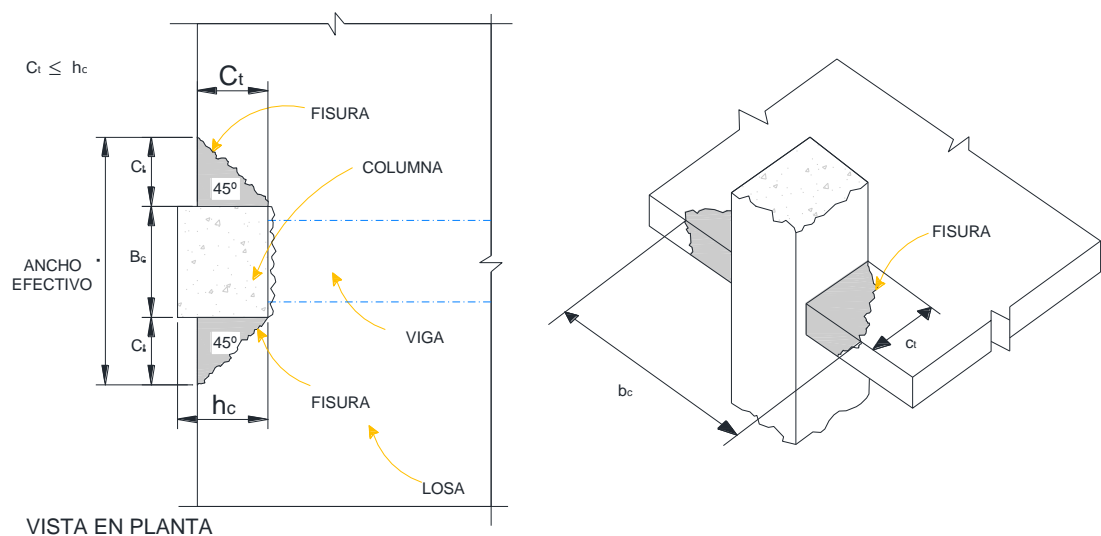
Ancho efectivo de viga en conexiones exteriores sin viga transversal
